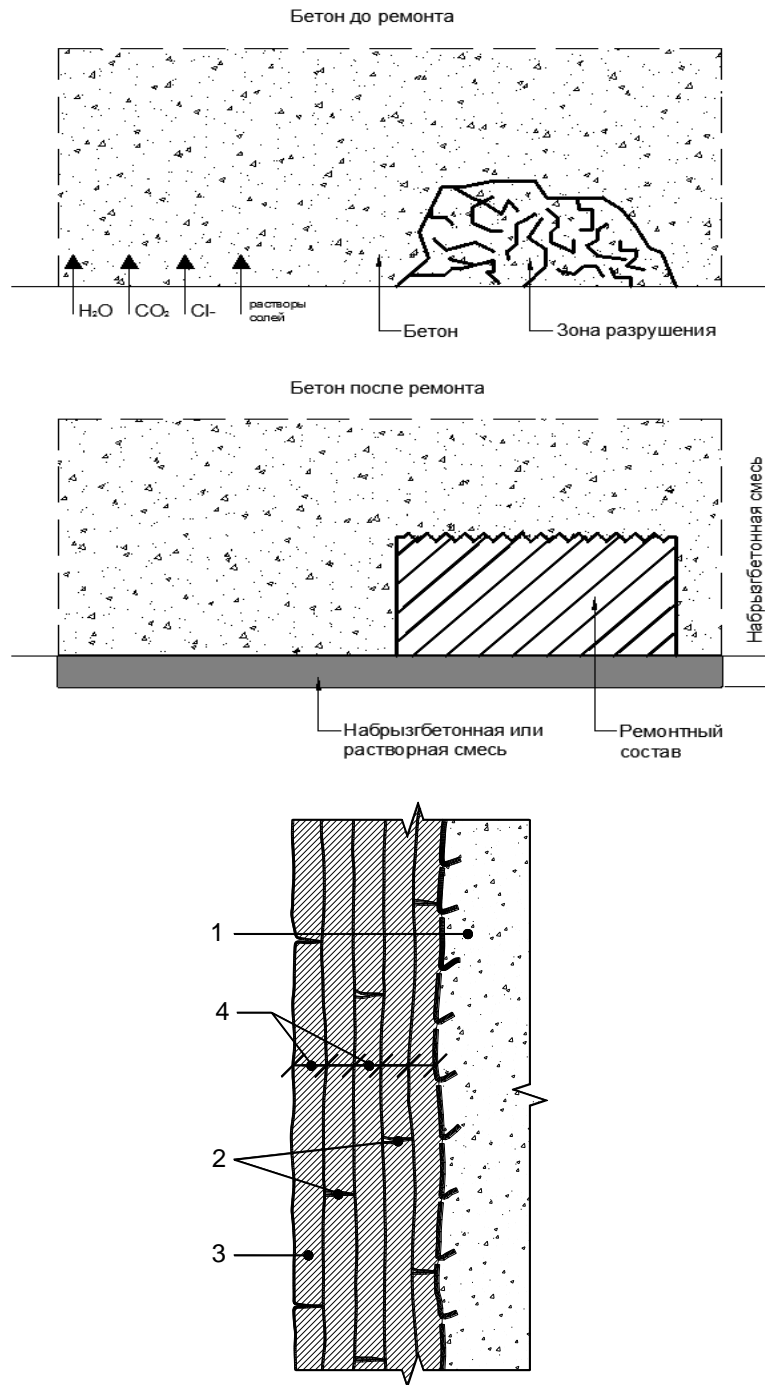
Нанесение набрызгбетонной смеси на нижние и вертикальные поверхности бетонной конструкции: 1 – старый бетон; 2 – усадочные трещины; 3 – слой торкрета/набрызгбетона; 4 – толщина слоев торкрета/набрызгбетона от 2 до 7 см
